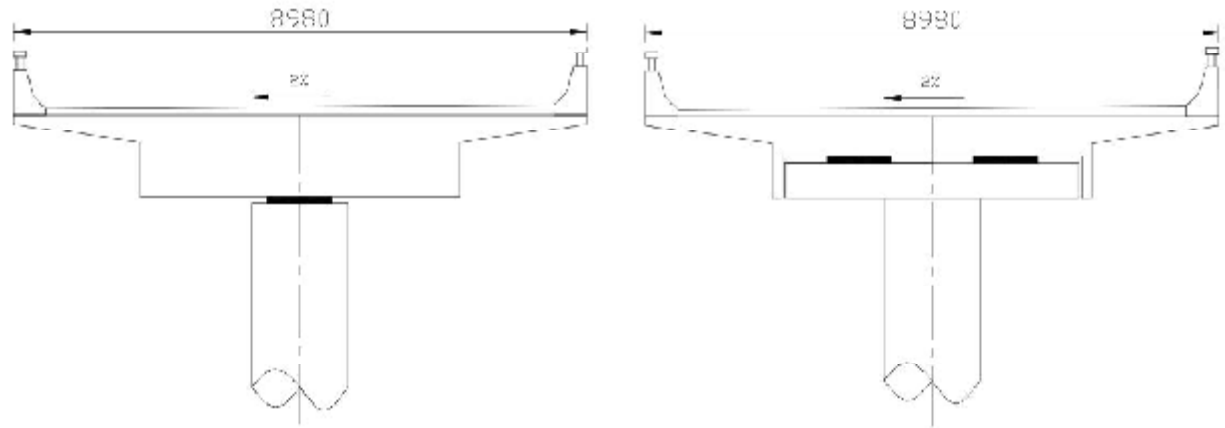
B 匝道桥梁端截面示意图 (单位: mm)
